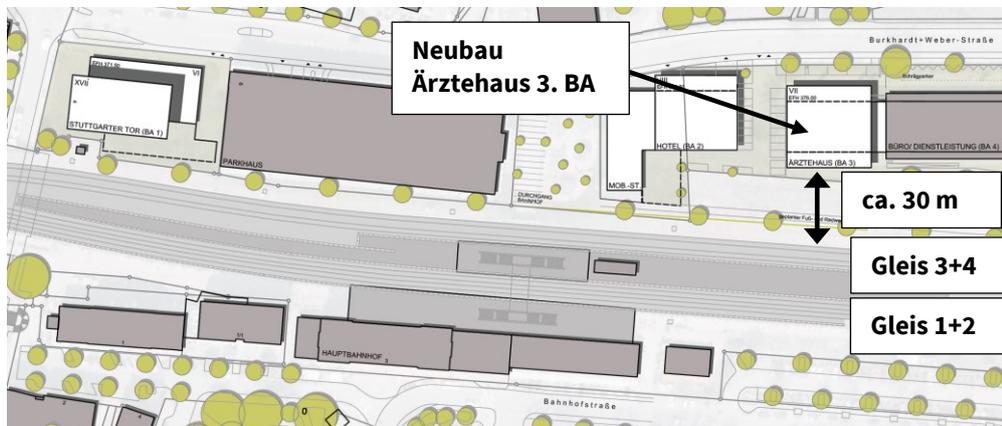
Lageplan, minimaler Abstand Neubau Büro- / Ärztehaus zu Gleis 4: ca. 30 m
